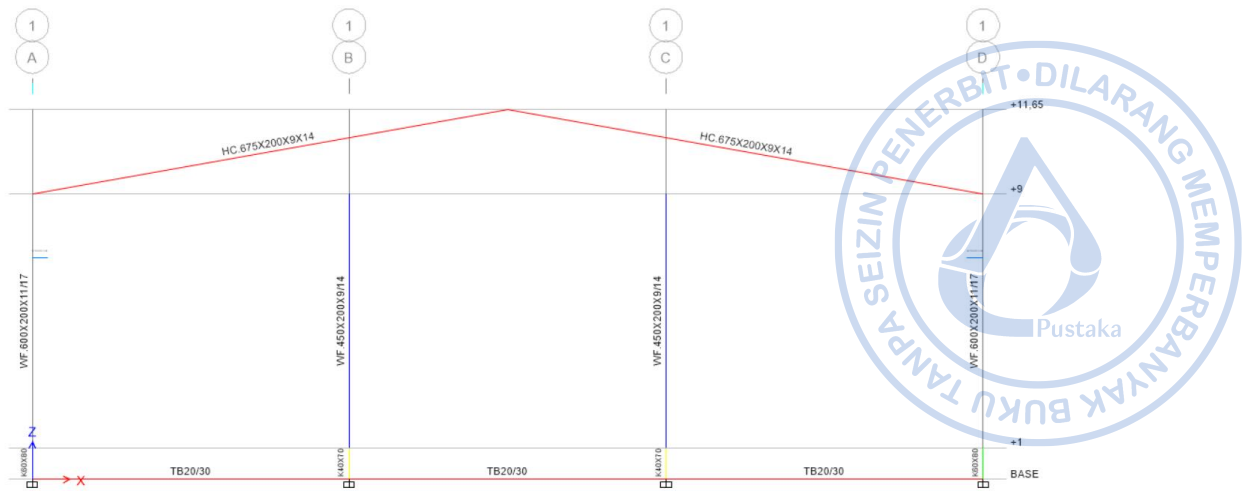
Draw/Column/Brace* (Plan, Elev, 3D)
